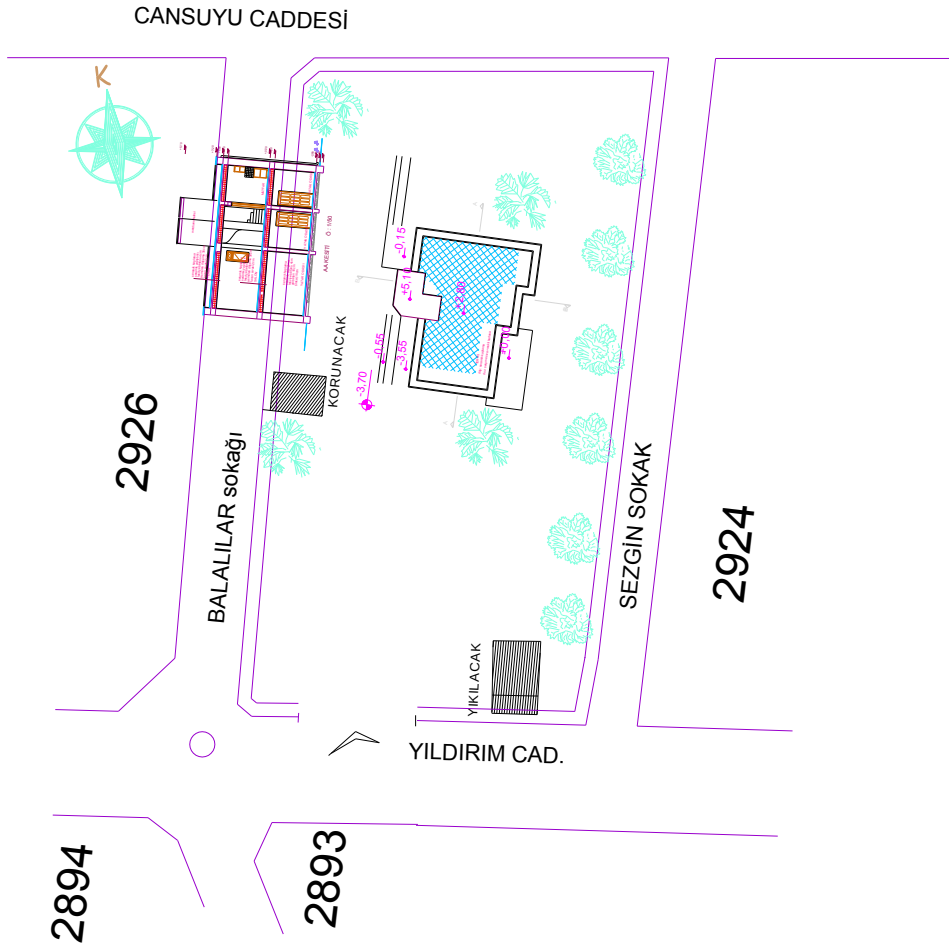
Yapının yönüne göre vaziyet planına yerleştirilmesi
